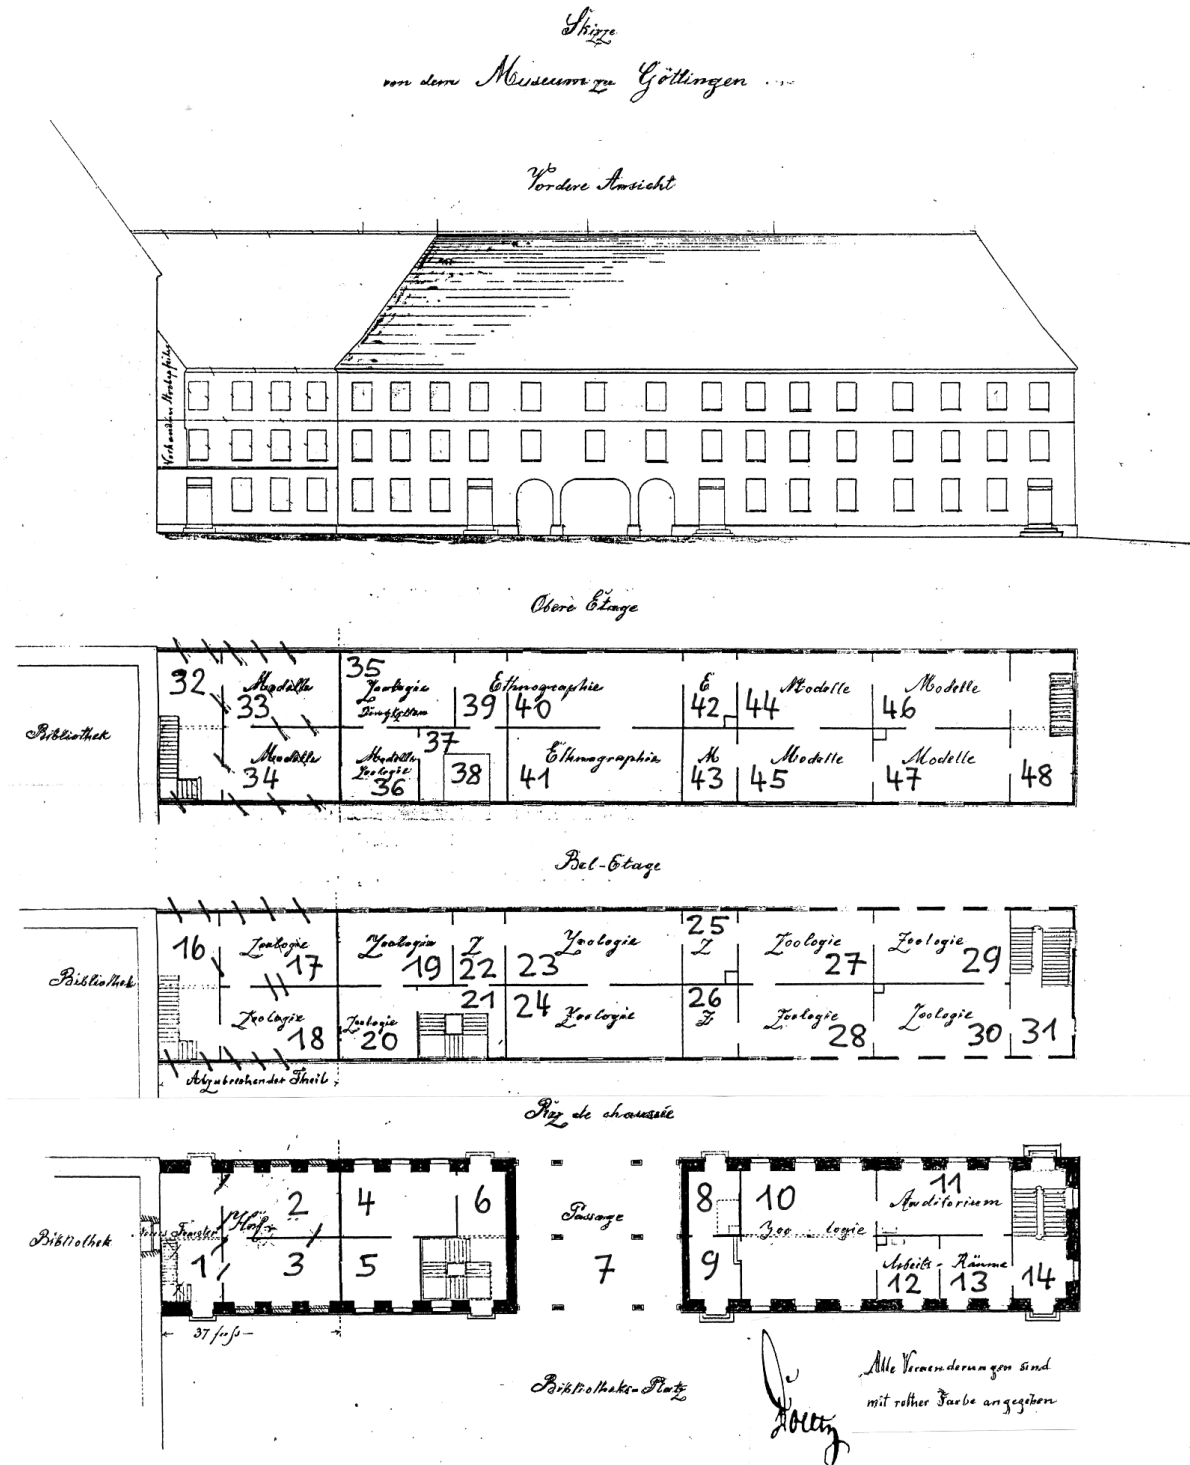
„Skizze von dem Museum zu Göttingen, Doelz“ Gebäudeansicht mit Berücksichtigung eines geplanten Teilabrisses, UAG Kur 13.1.49 (= Kur 9321) Plan fol. 43.
